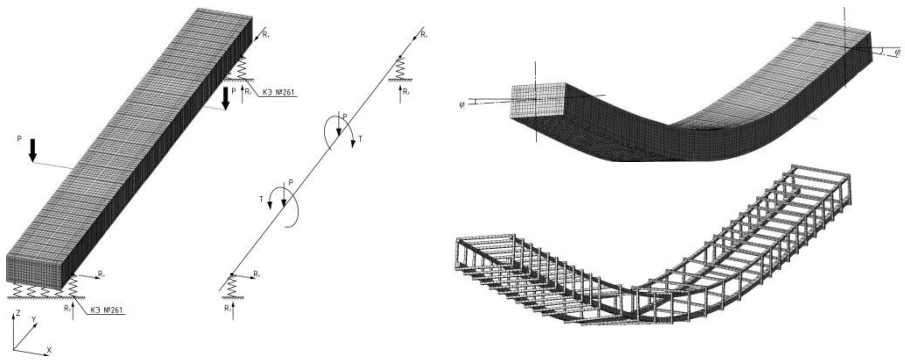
Расчетная схема и схемы деформирования образца и арматурного каркаса
